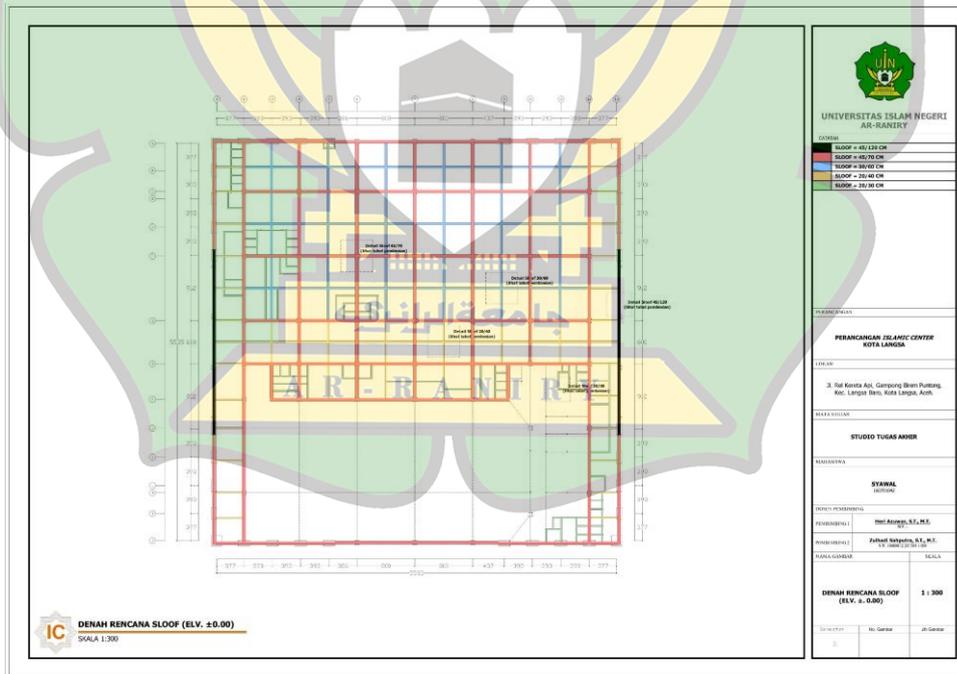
Denah Rencana Sloof (ELV. -1.00)
